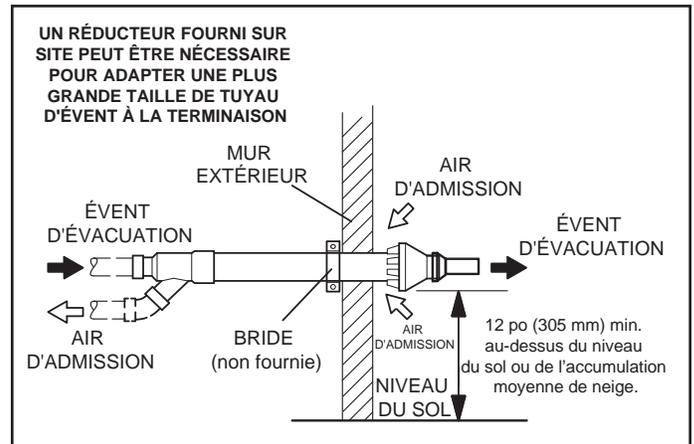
Terminaison d'évent facultative pour installation de plusieurs unités de terminaisons murales en ventilation directe
